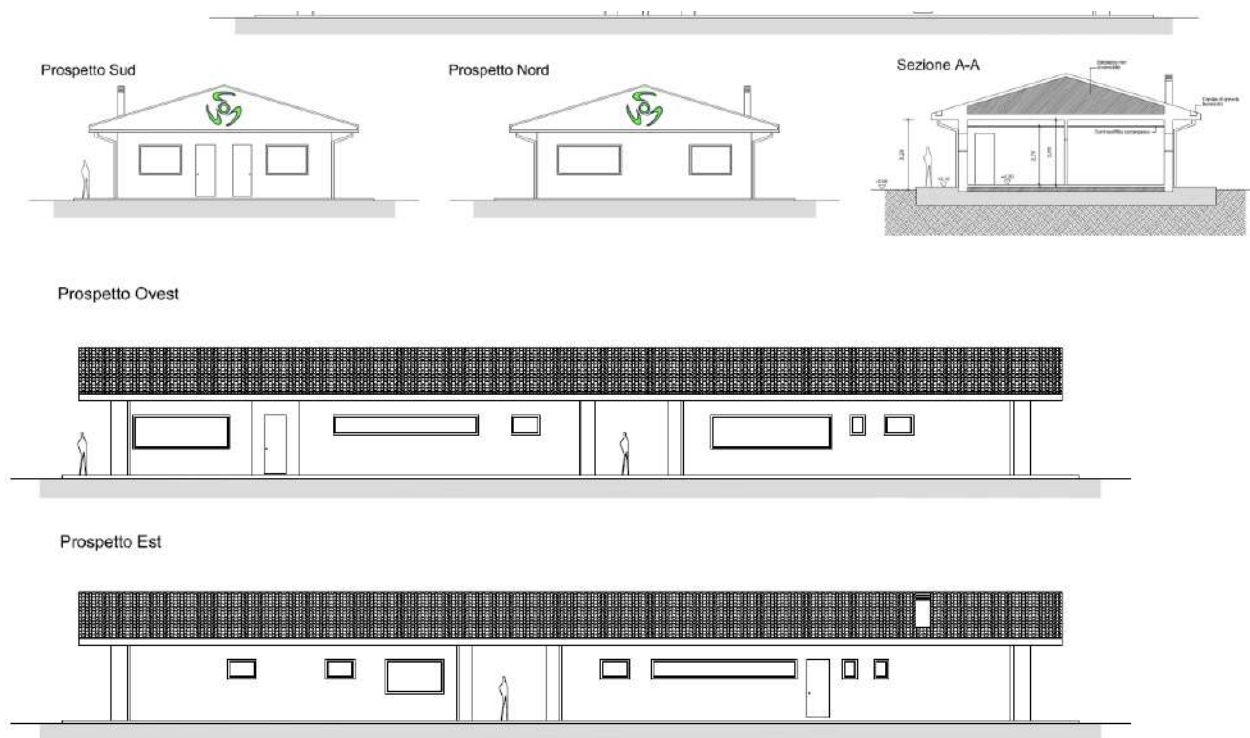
Prospetti e sezioni dell'edificio previsto nel progetto
